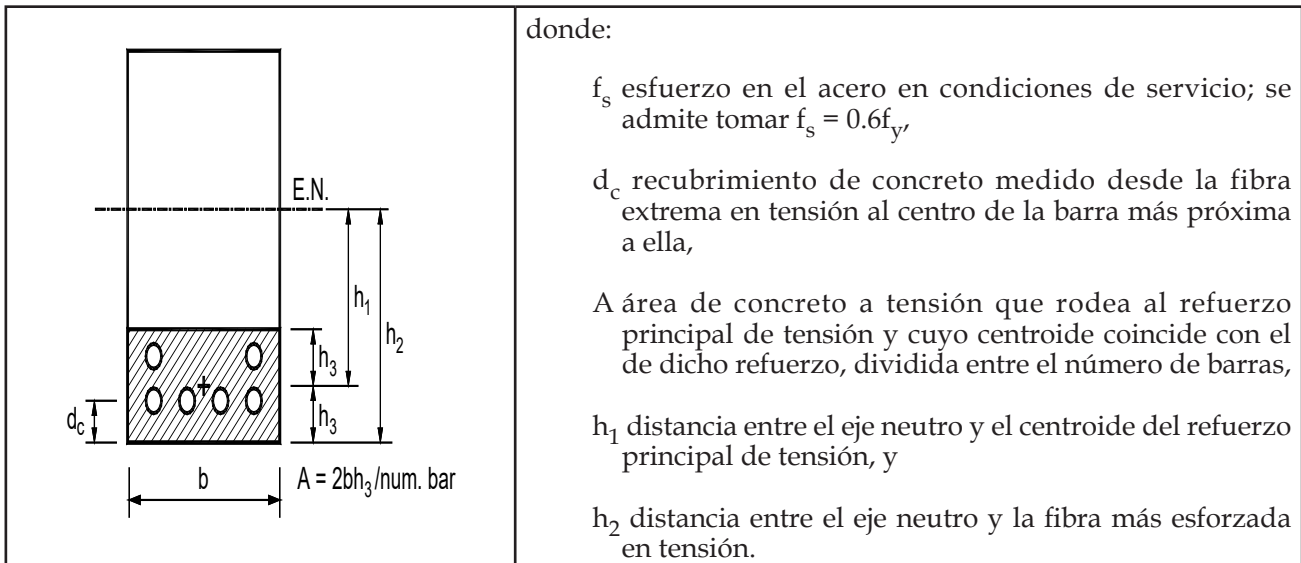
DISEÑO POR AGRIETAMIENTO EN VIGAS Y LOSAS EN UNA SOLA DIRECCIÓN
